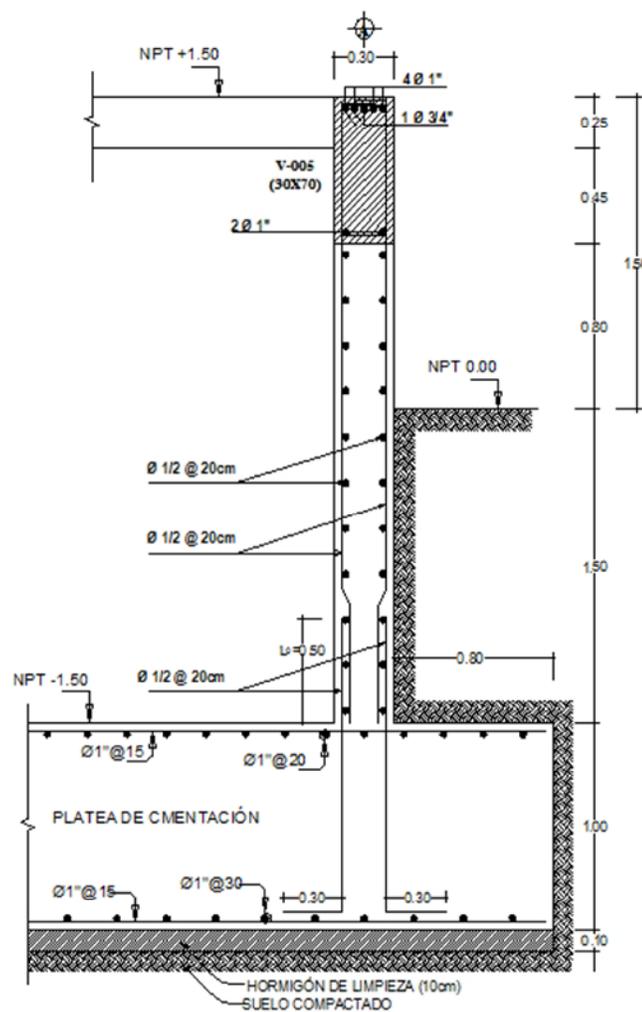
Esquema del Armado Final para el Muro de Sótano, Corte 2-2.
